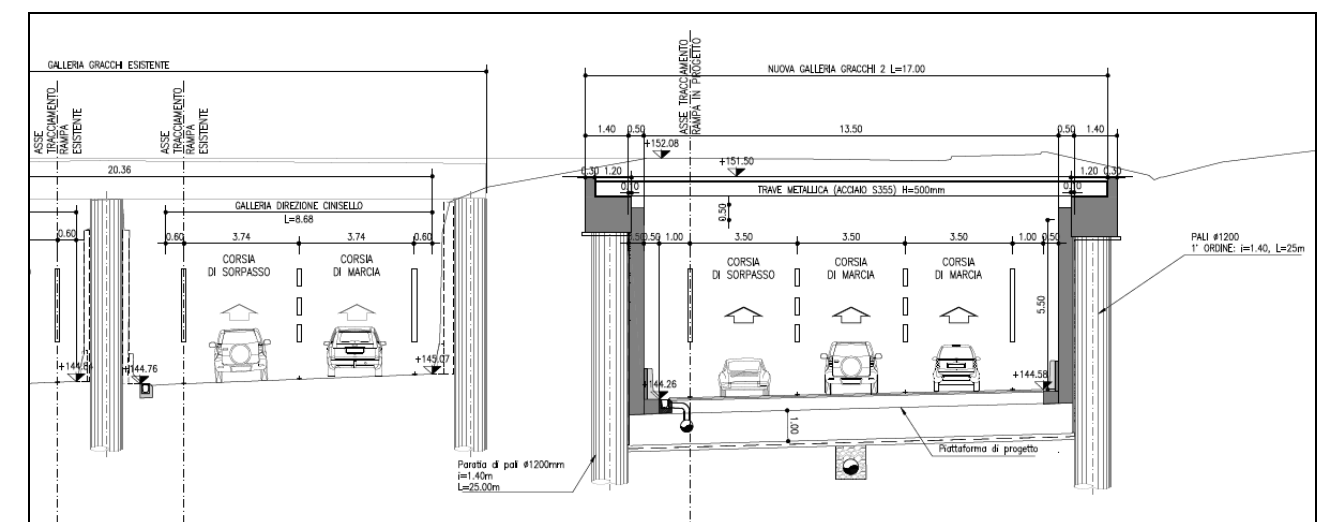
Sezione Galleria artificiale Gracchi 2
